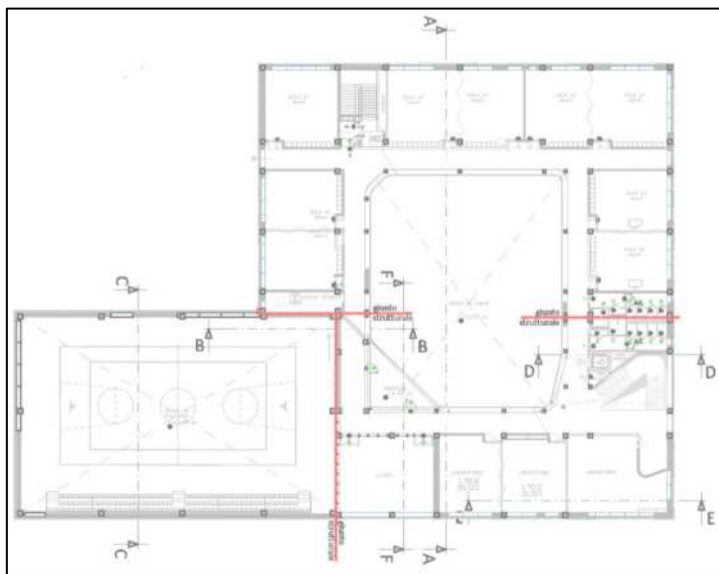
Planimetria piano terra del nuovo edificio e della palestra
